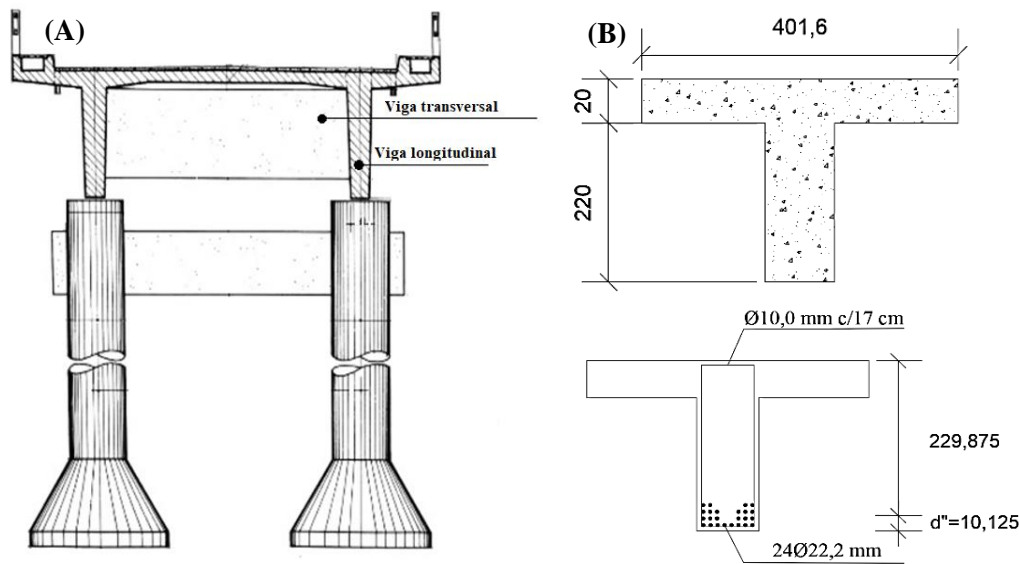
(A) Perfil transversal del puente sobre el Rio Chapecó; (B) Sección transversal, en centímetros, del trecho investigado de la Viga longitudinal (Adaptado del Departamento de Estradas e Rodagem de Santa Catarina, 1987).
